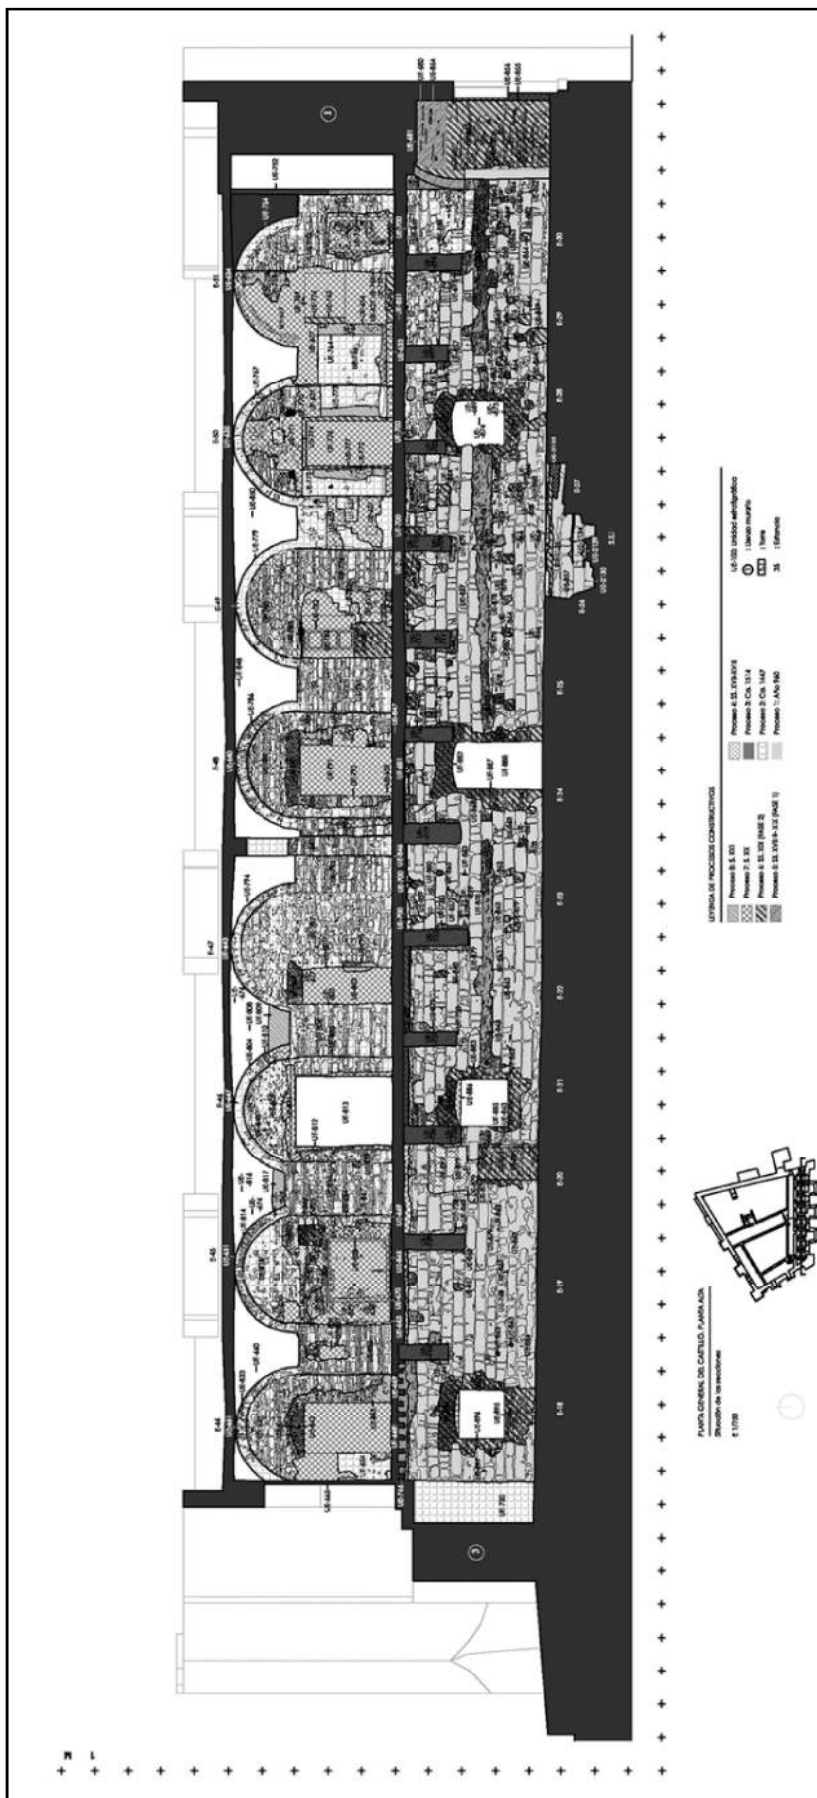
Estudio de alzados del muro meridional del pabellón sur. En rojo el aparejo de sogas y tizones, destacando en la primera planta los restos del adarve conservado.
